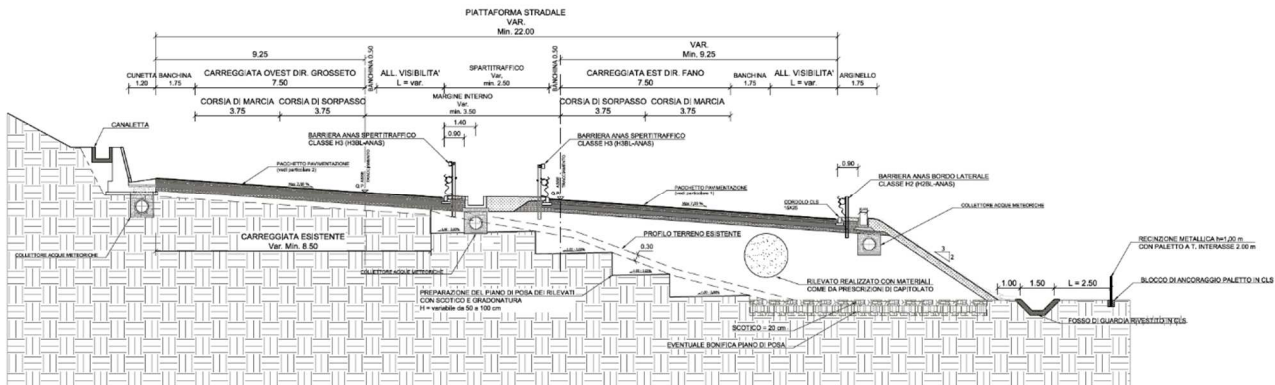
Sezione tipo a mezzacosta in rettilineo con muro a margine
